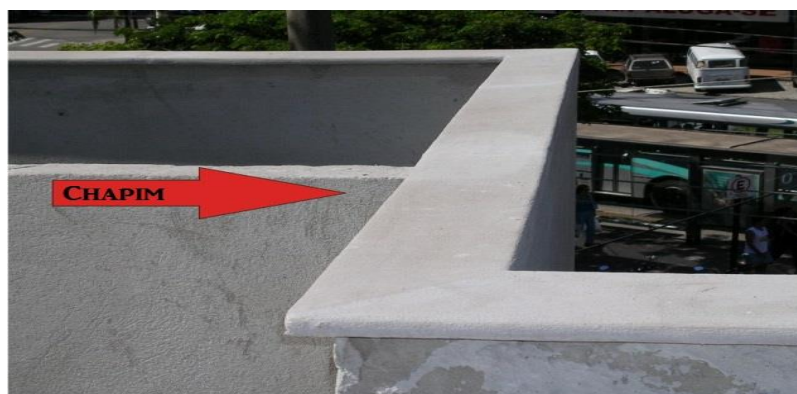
chapim (ou capa de muro) em concreto pré-moldado
